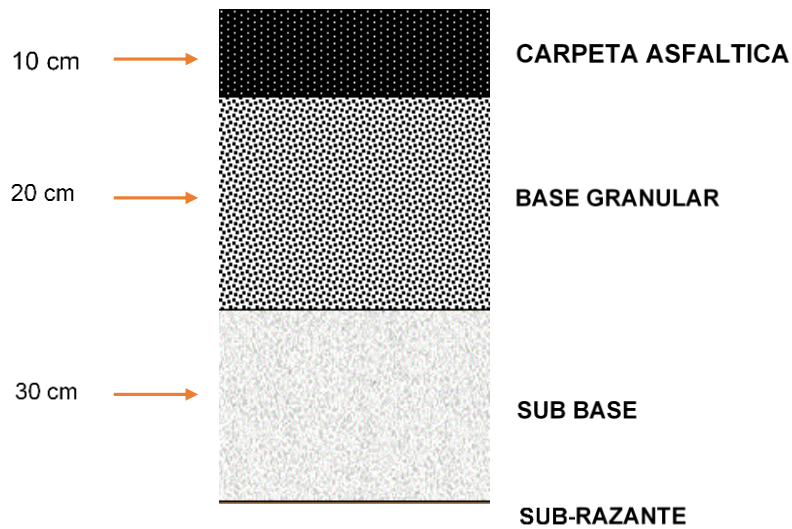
Estructura del Pavimento Flexible Mediante la Metodología AASHTO-93.
